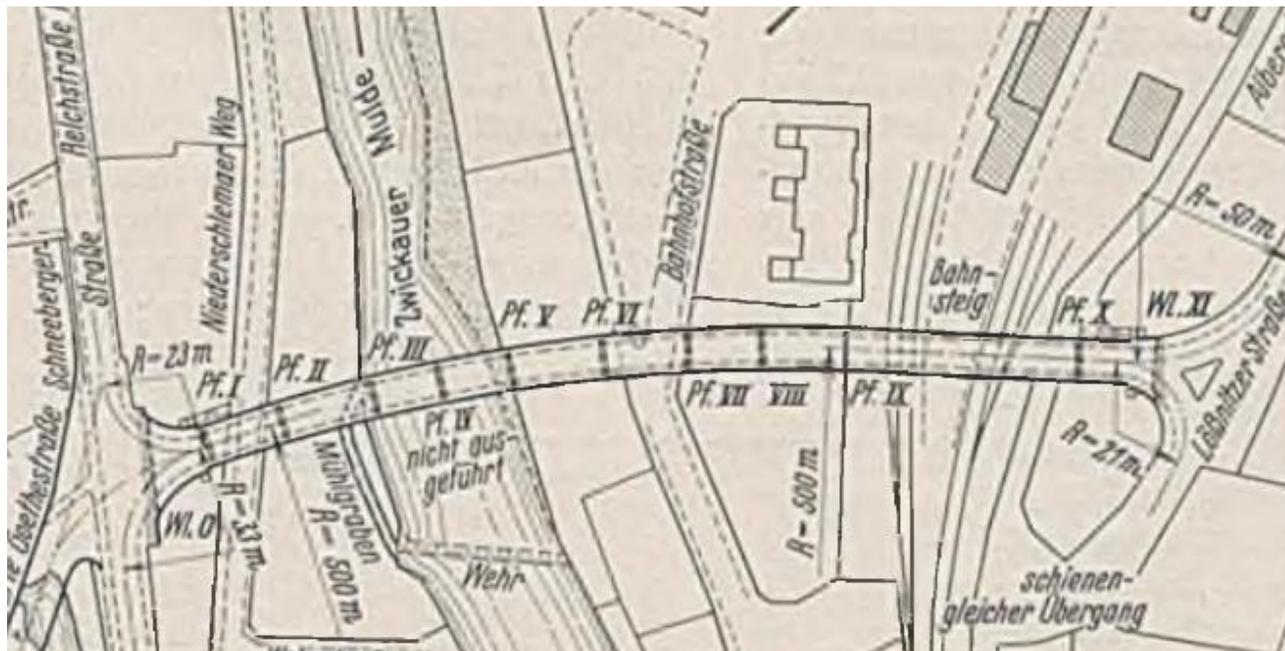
Übersichtsplan mit Widerlager- und Pfeilernummerierung [2, S.97 Abb. 1]; Pfeiler 4 entfiel später
